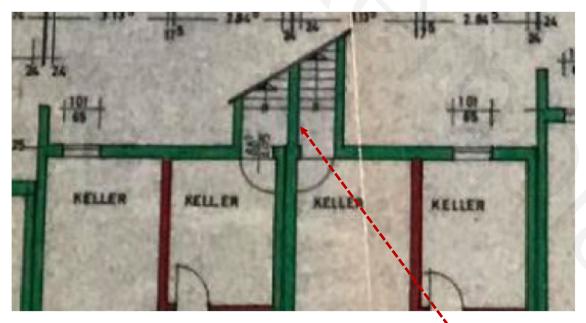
Auszug aus der Eingabeplanung, Grundriss UG:
